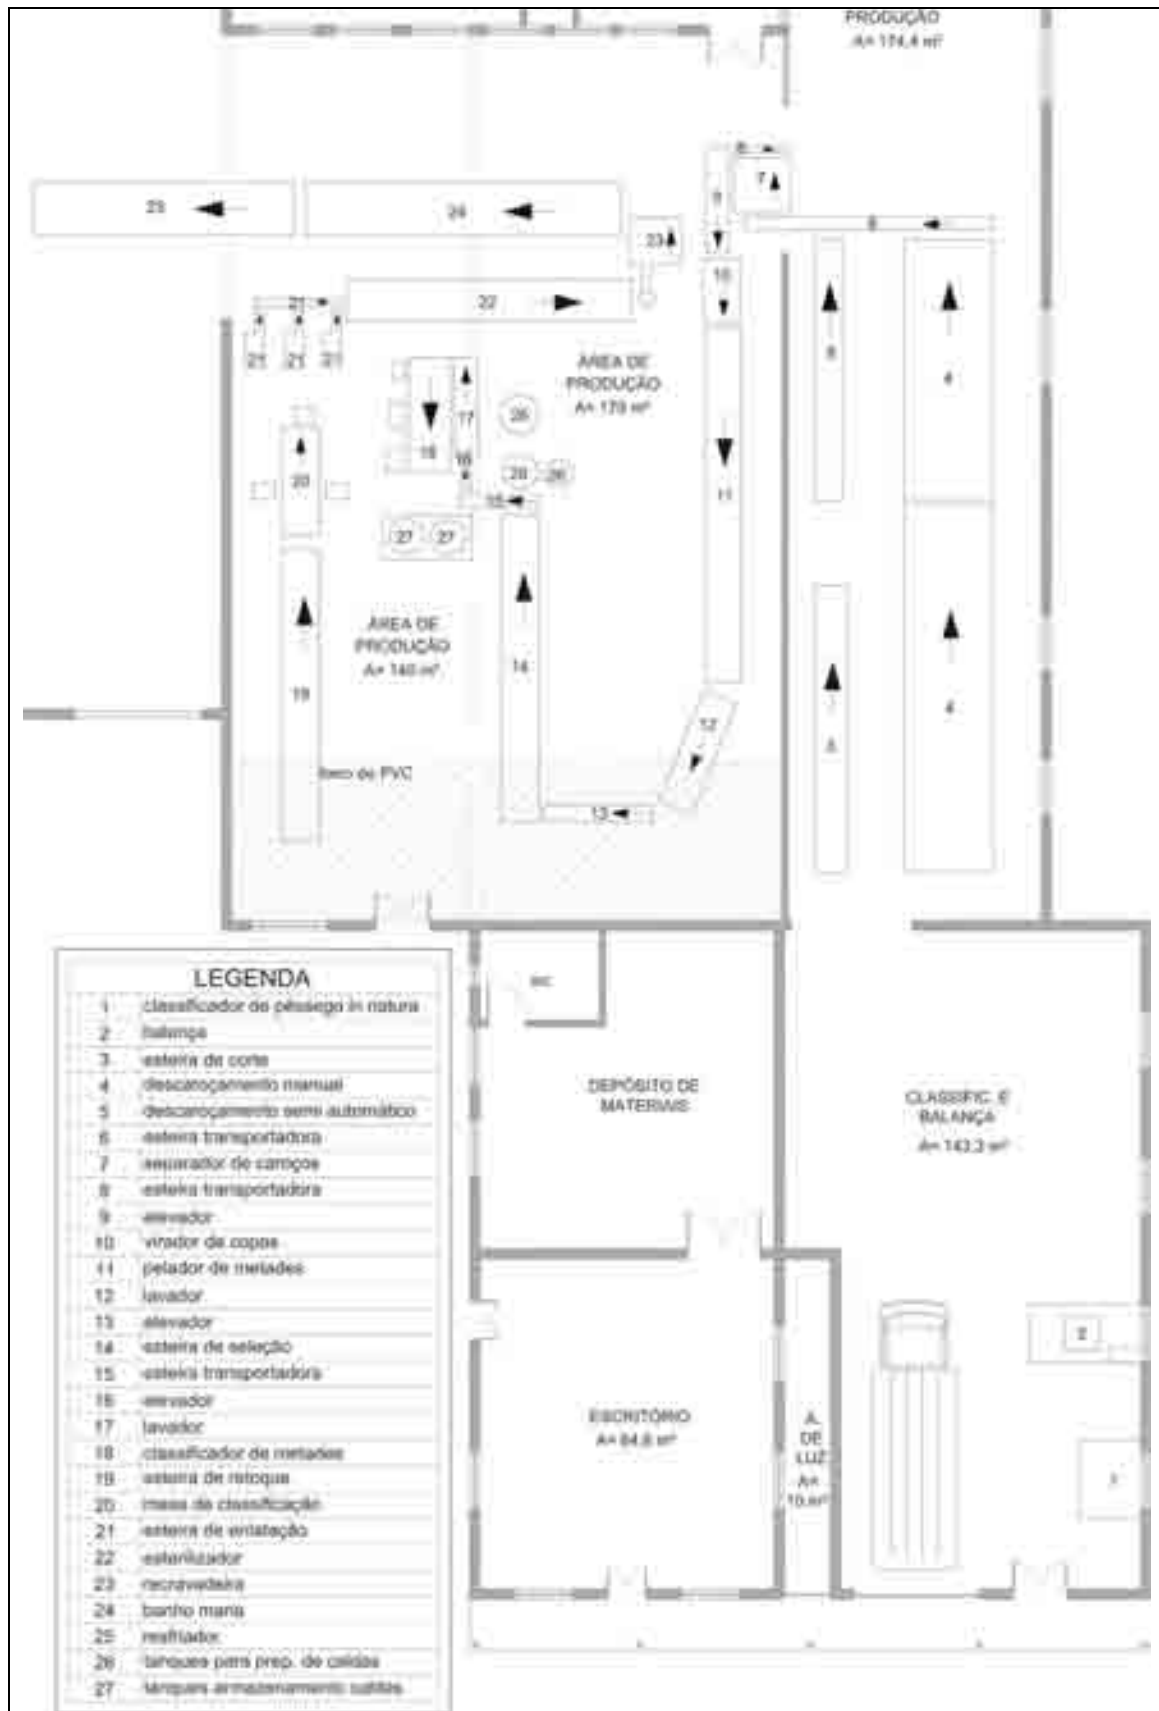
Recorte da planta baixa da Indústria de Conservas Patzlaff.
